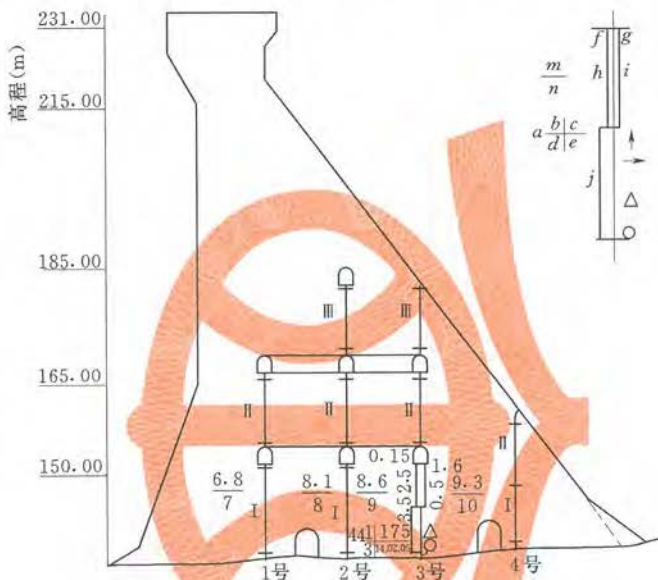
混凝土坝接缝灌浆(纵缝)综合剖面图
